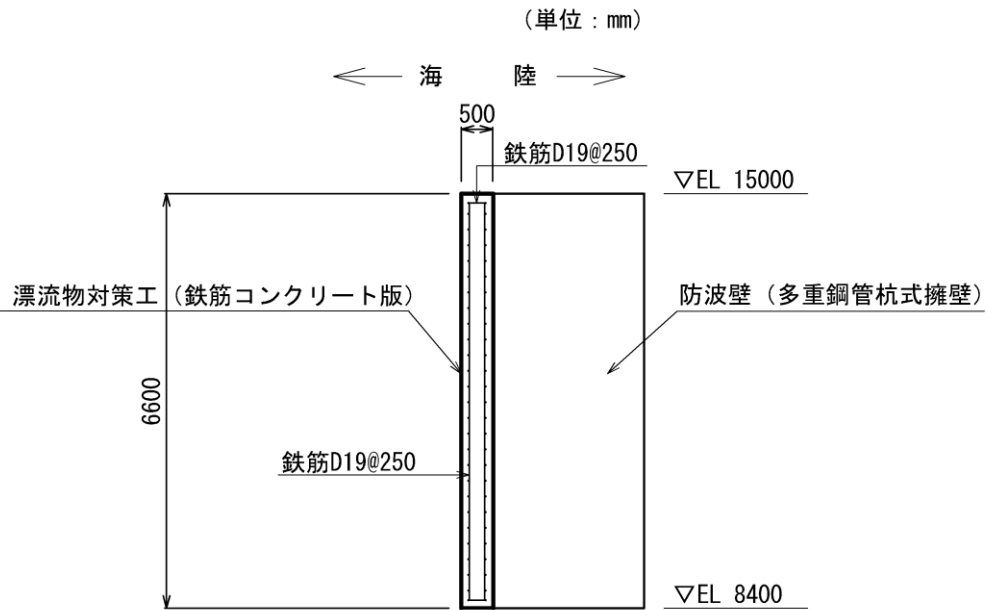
(2) 漂流物対策工 (鉄筋コンクリート版) の概略配筋図 (断面図)
